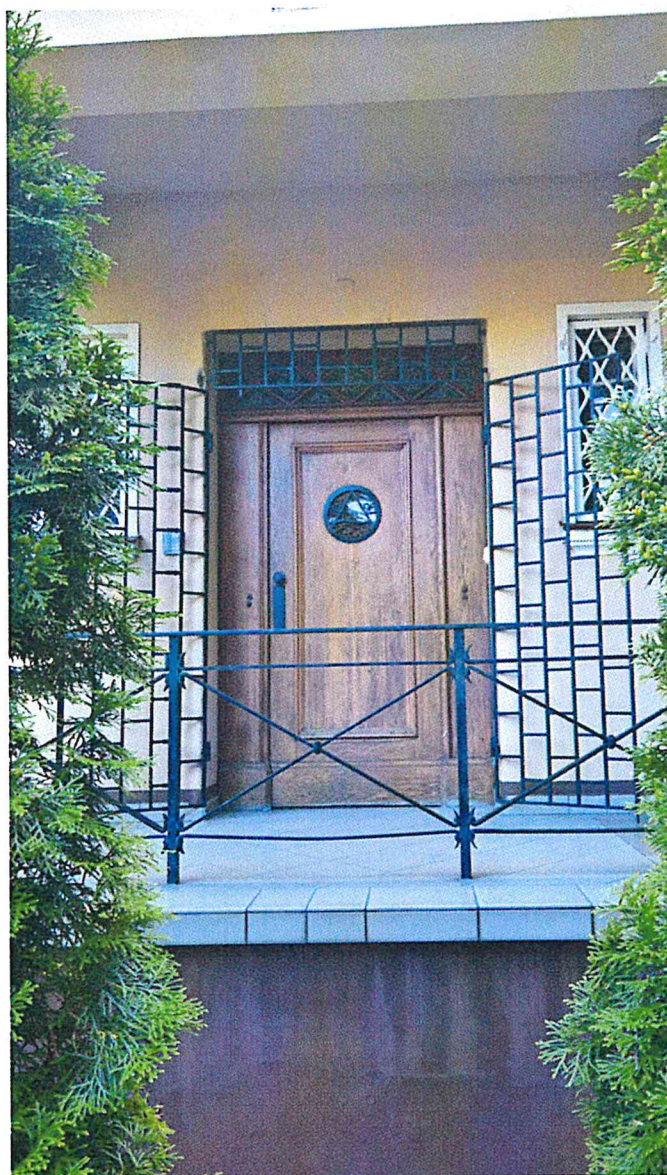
elewacja zachodnia – widoczne odparzenia tynku na cokole
